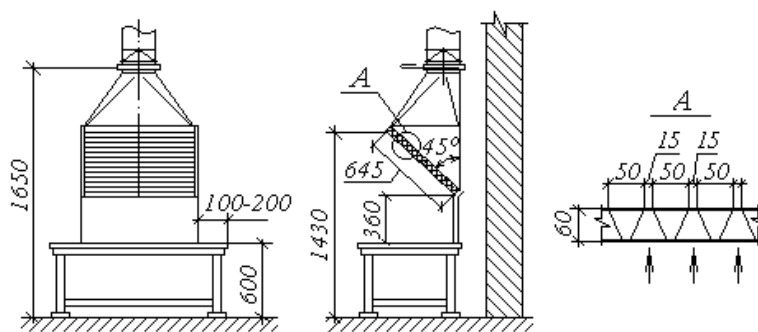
Схема установки отсасывающей панели у поста сварки
